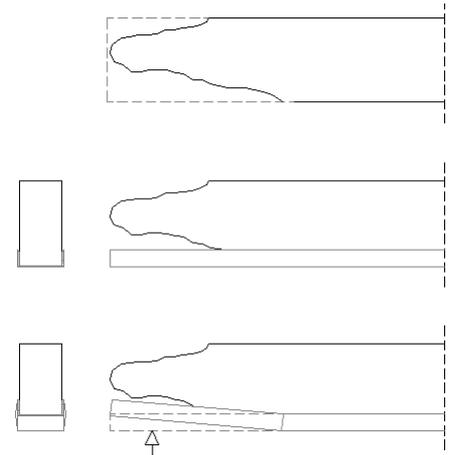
2 Refuerzo mediante perfil metálico. 2016. Croquis propio
